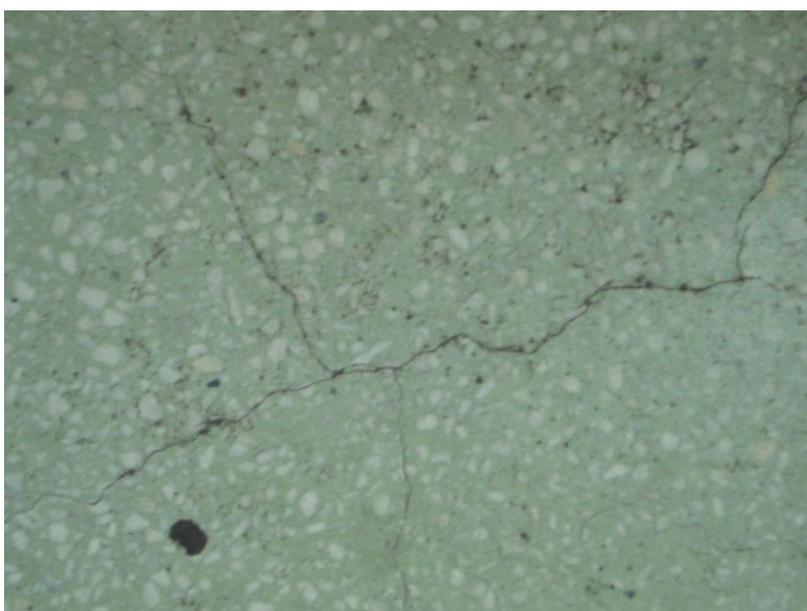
Piso interno original, após recuperação – fissuras não preenchidas e sinais de desgaste superficial. Foto da autora.
